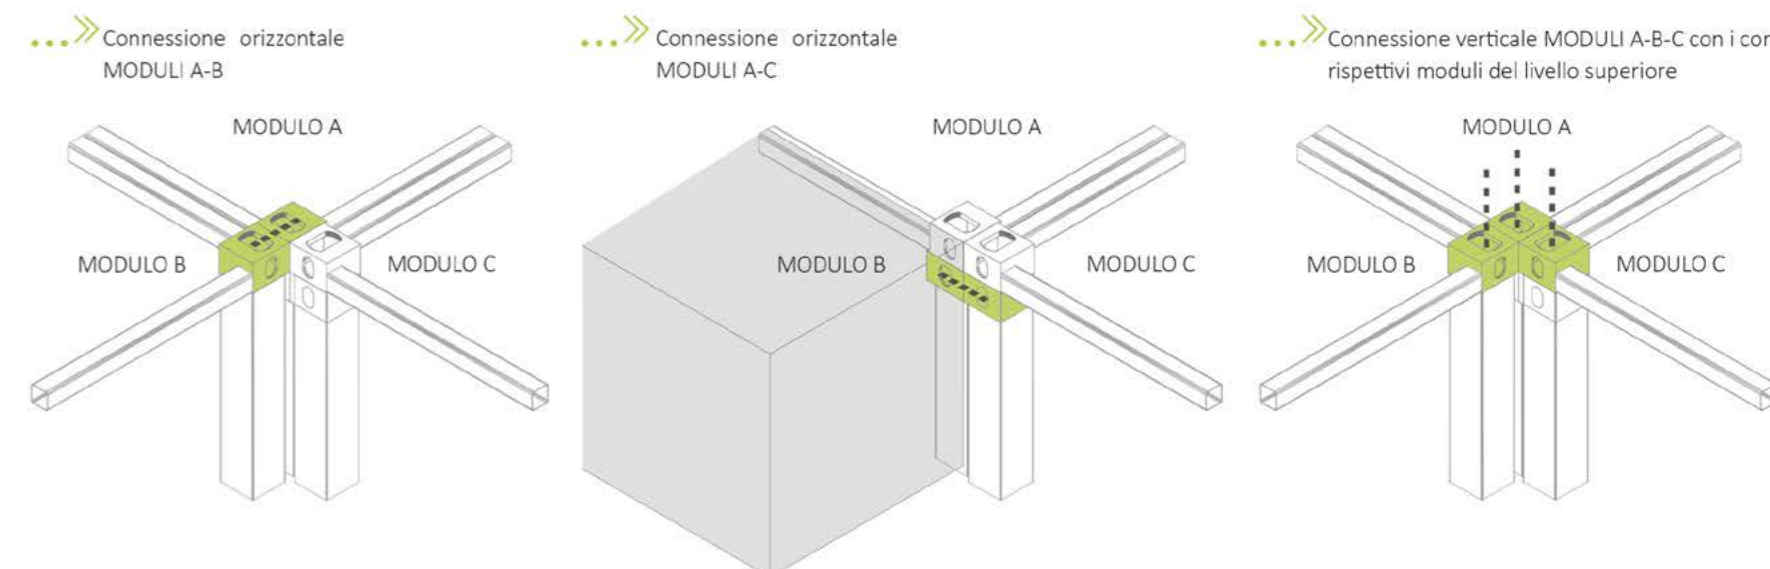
Dettaglio fissaggio verticale e orizzontale tra più moduli in acciaio.
